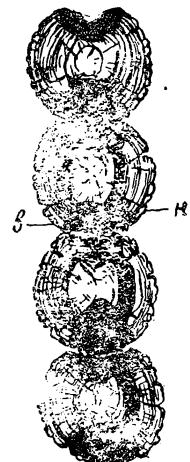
Поперечный разрез бревен нижних венцов жилого дома.
